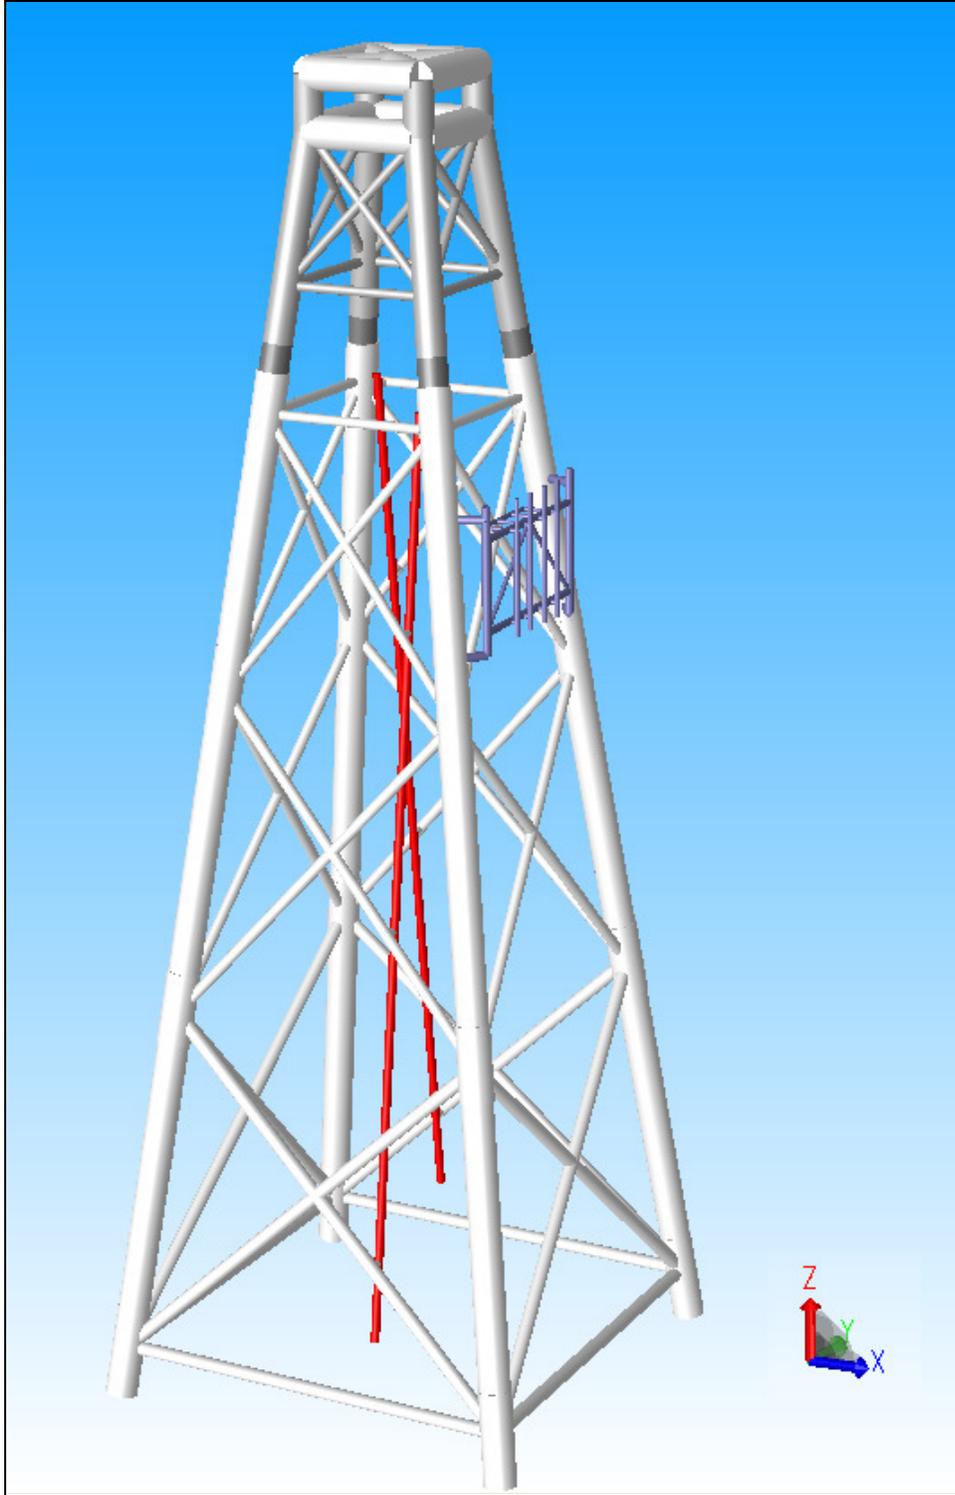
Vista d'assieme della fondazione (in bianco il jacket, in rosso i due J-tube, in grigio il deck, in blu la struttura del boat landing)
